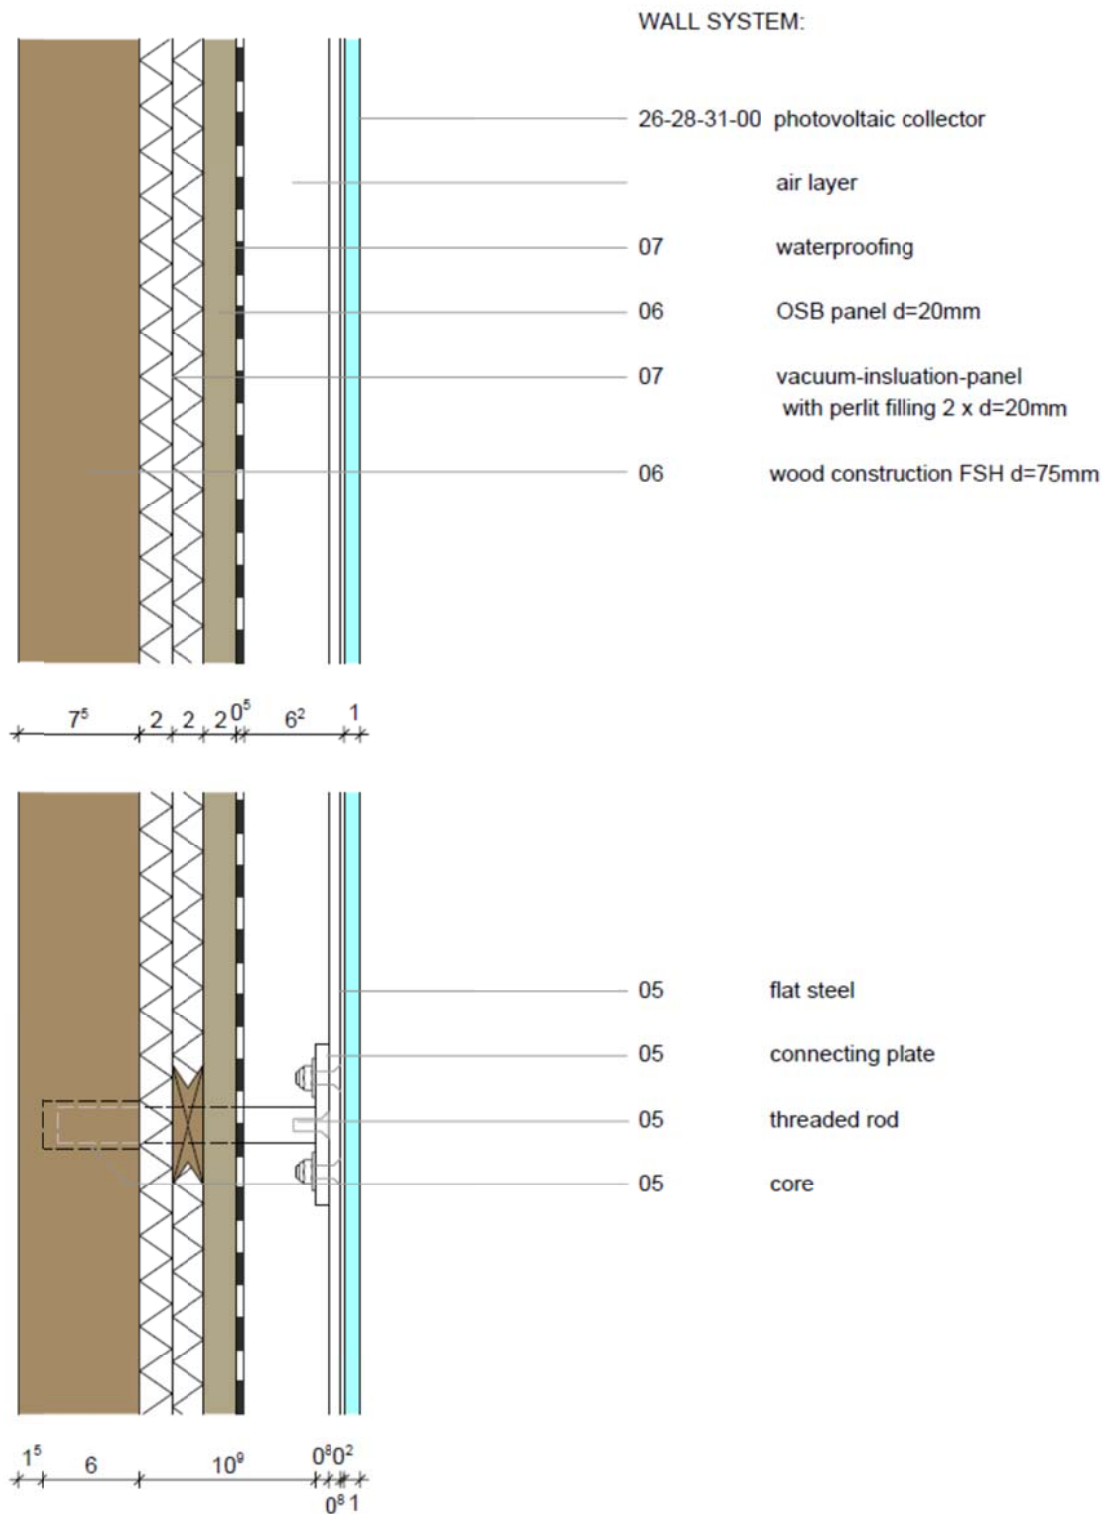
Sección horizontal y vertical fachada Este y Oeste. Fuente: HFT_CD_2010-09-22
